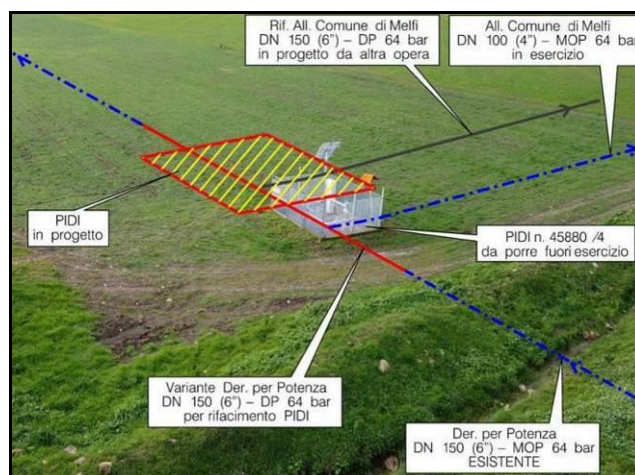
/B – Int. 2 – Impianto esistente da dismettere ed area impiantistica in progetto (in rosso)
